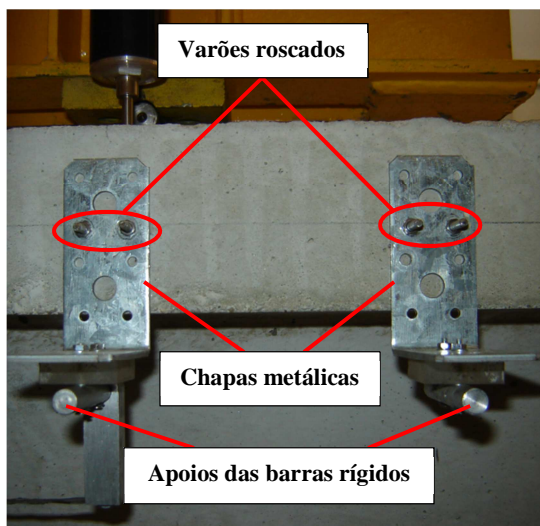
Sistema de ligação dos transdutores de deslocamentos horizontais à viga em estudo
